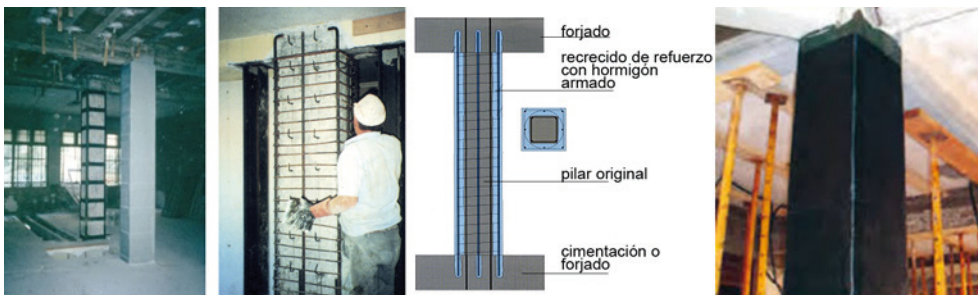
En la foto de la izquierda, refuerzo de pilar con empresillado metálico. En las dos fotos centrales, refuerzos mediante reguesados con hormigón armado. La foto de la derecha muestra el refuerzo usando fibra de carbono para conformar el zunchado del pilar.
